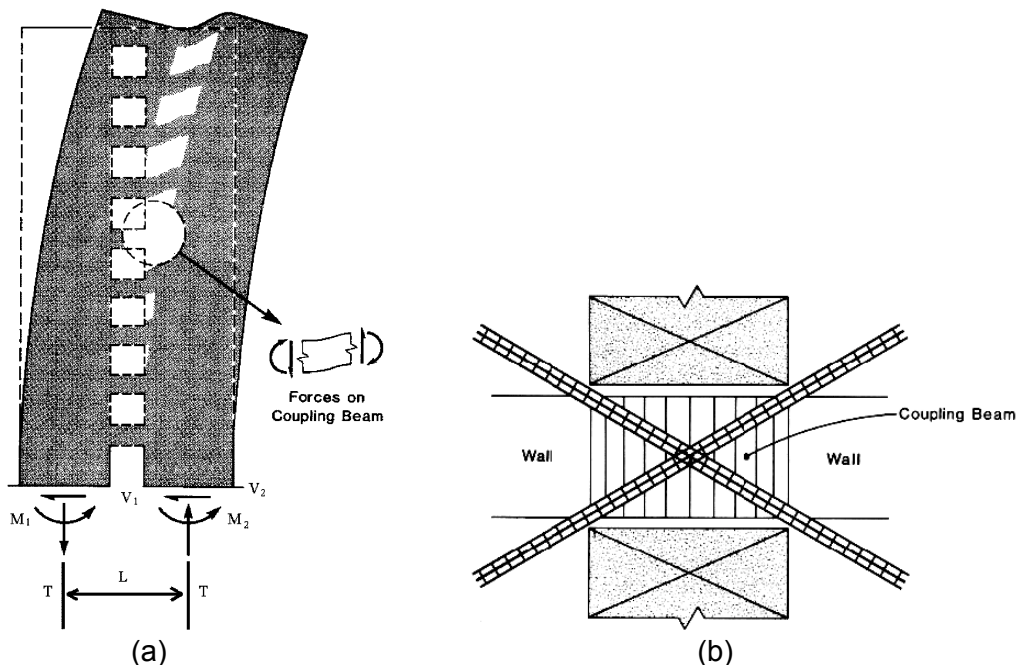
Eforturile dintr-un perete cuplat (a) și armarea diagonală a grinzii de cuplare (b), Derecho și Kianoush, 2001.
